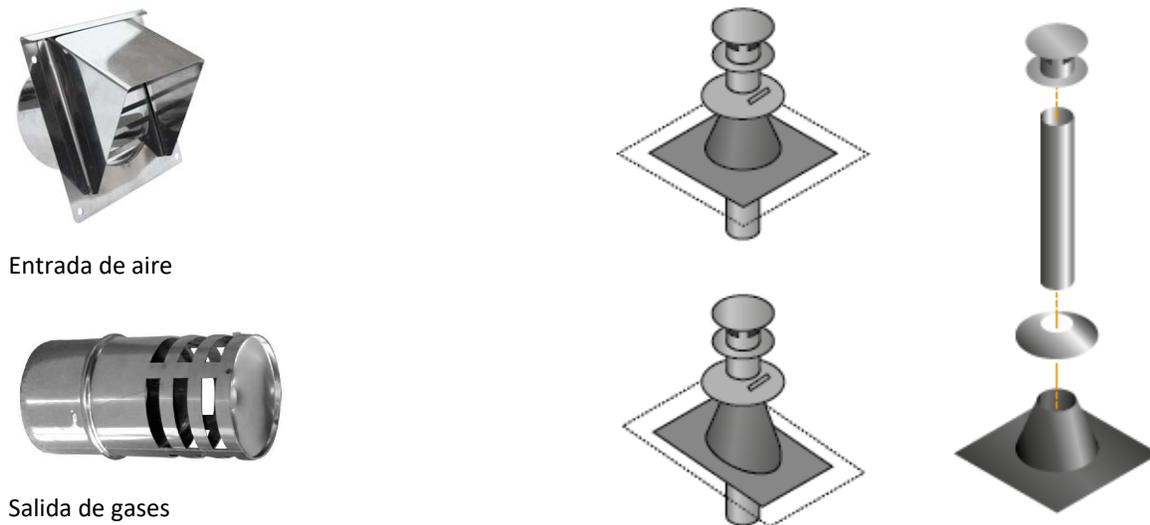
Opción vertical única y concéntrica montada en el techo. Montado en pared terminales simples y concéntricos, horizontales y verticales.
